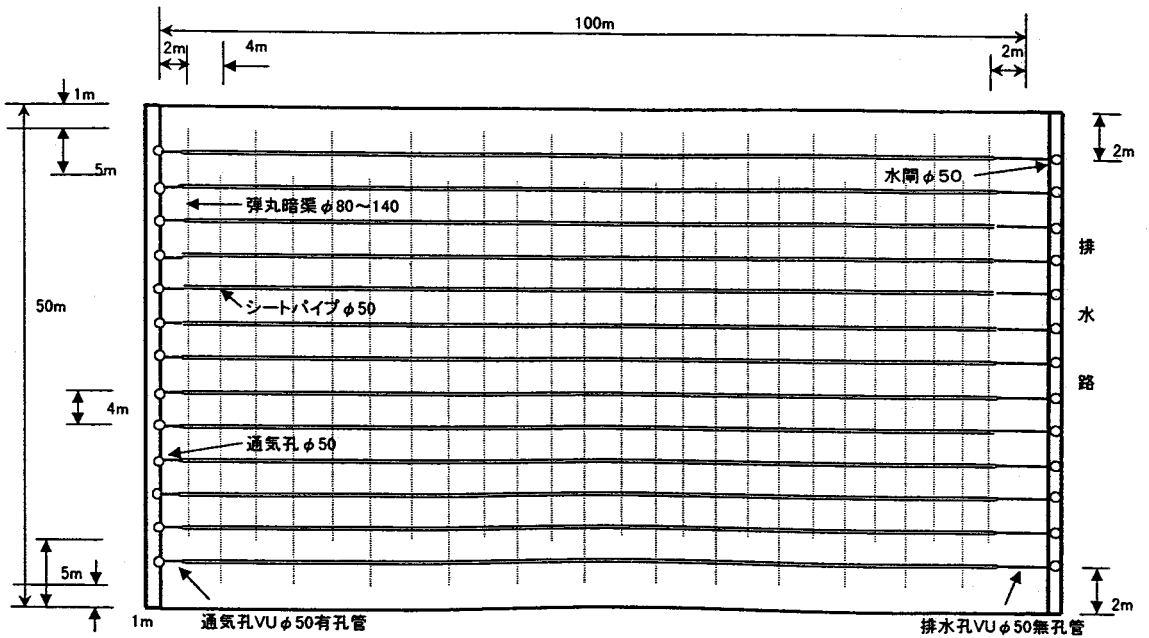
1 開削暗渠工法(従来型)標準平面図
